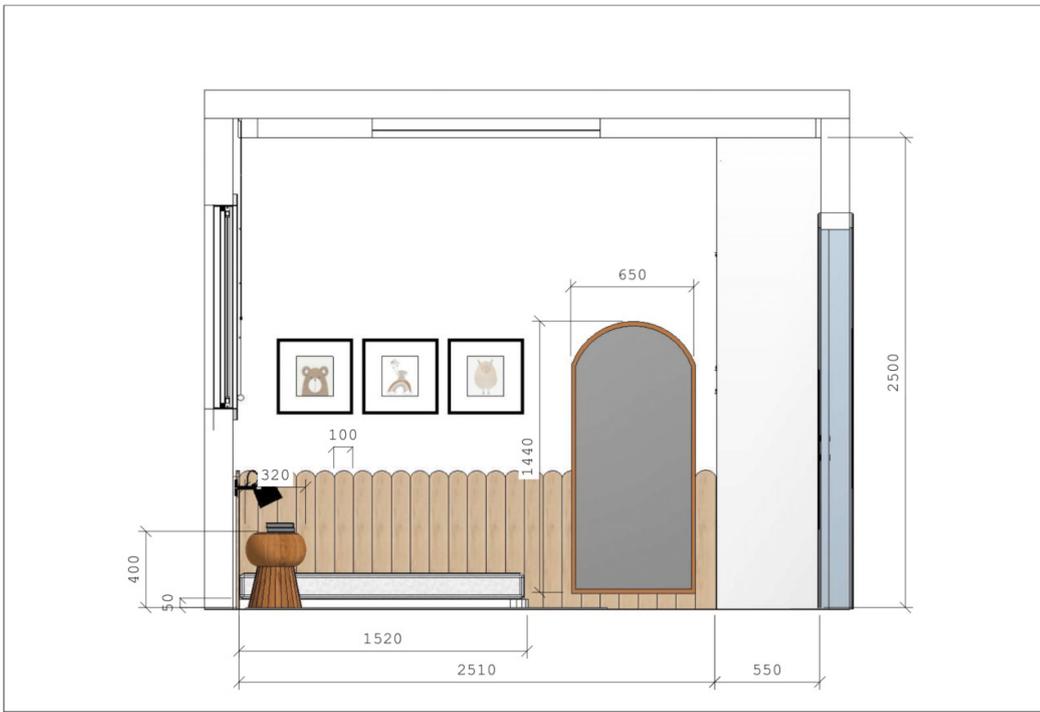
Detalhamento imagem 2. Fonte: Autora.
